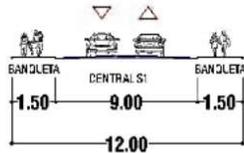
Calle Vicente Guereca. Sección actual PDU 20410.
